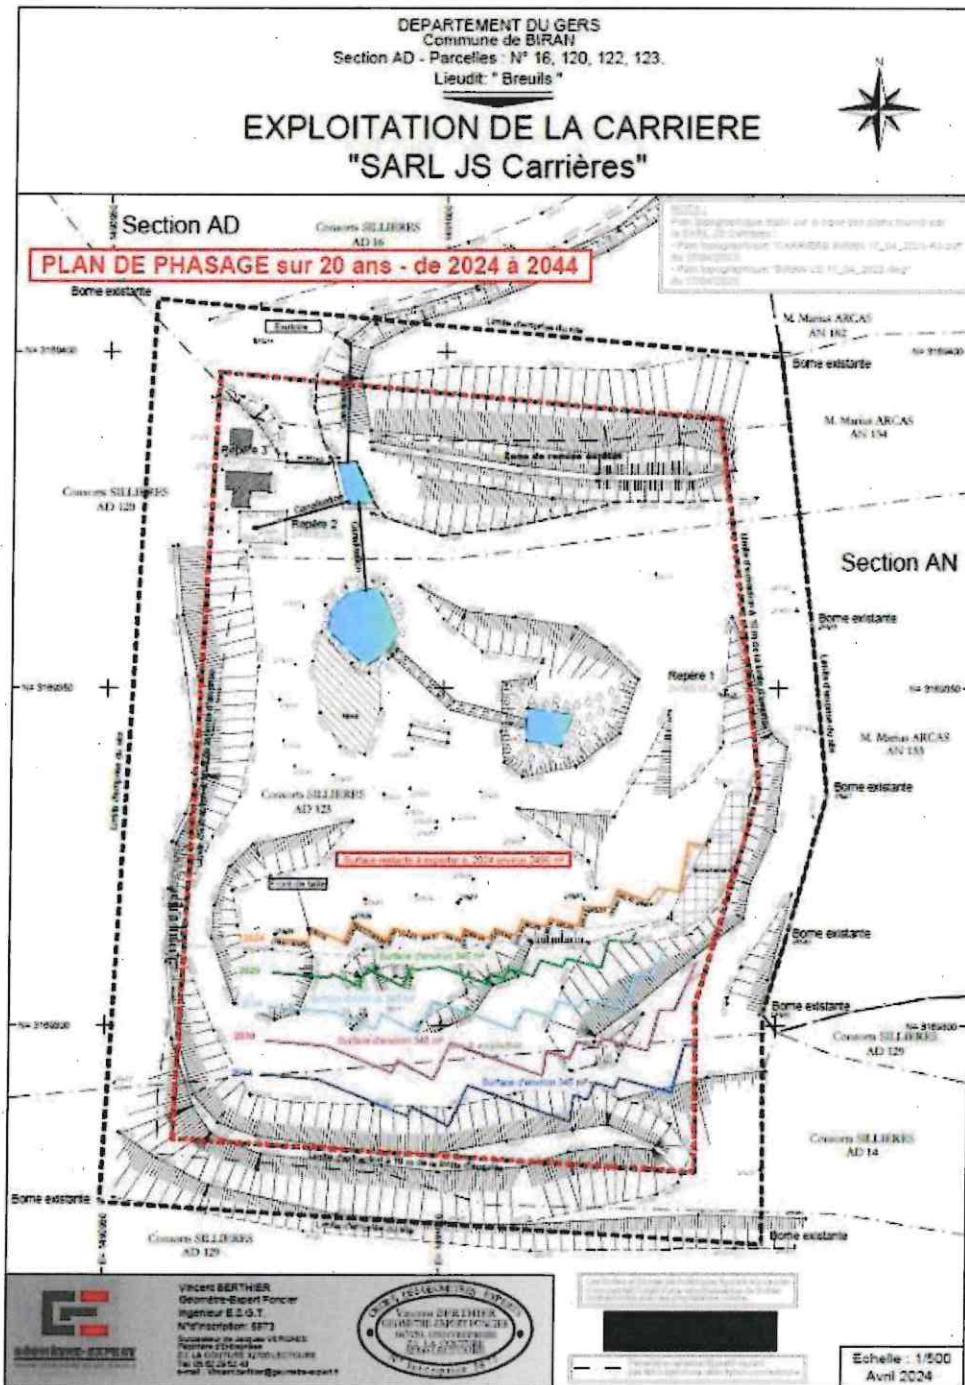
Plan de phasage (Source : JS CARRIERE)
